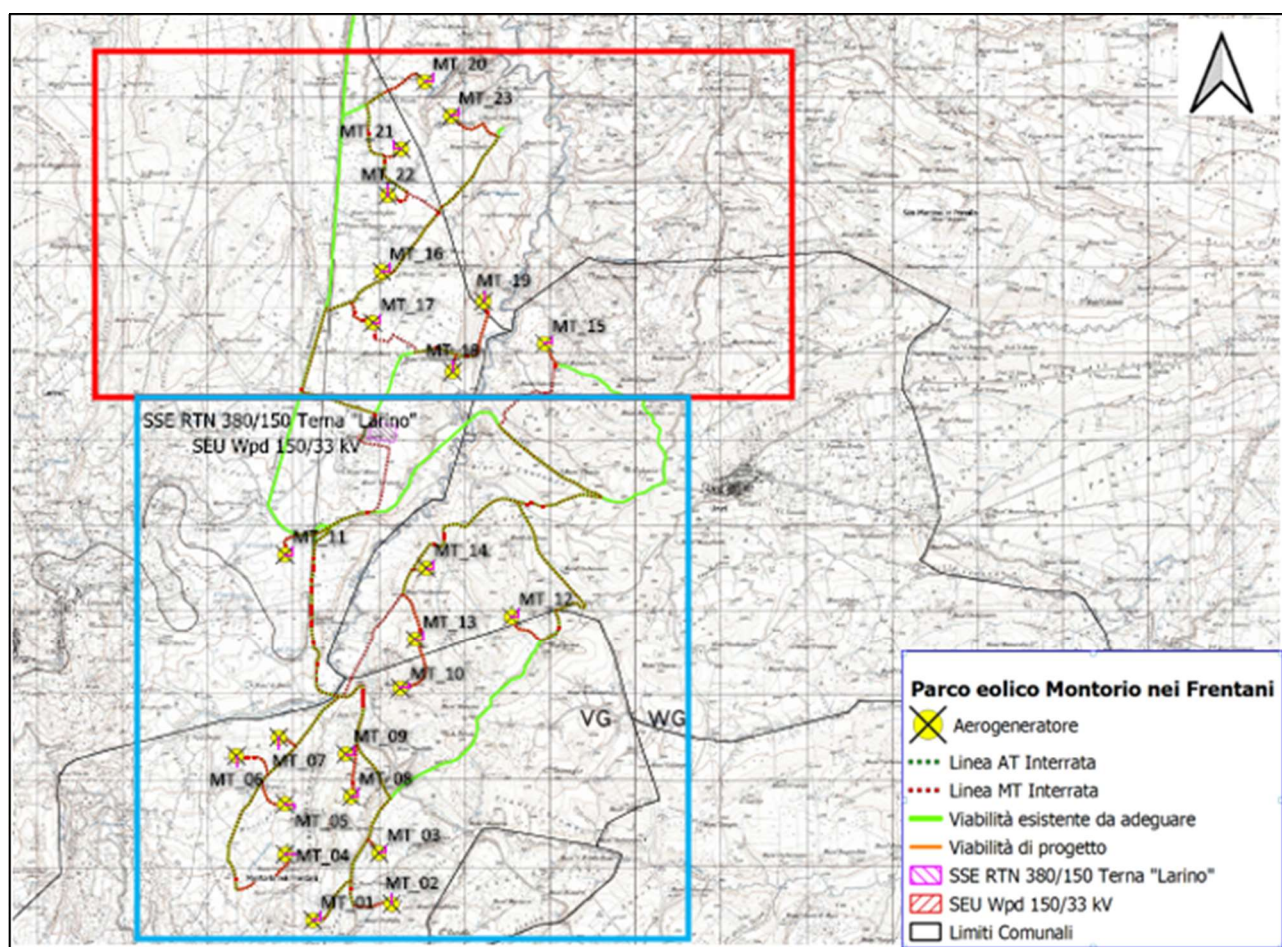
Layout d’impianto suddiviso in zone su IgM: Zona 1, rettangolo rosso – Zona 2, rettangolo azzurro
